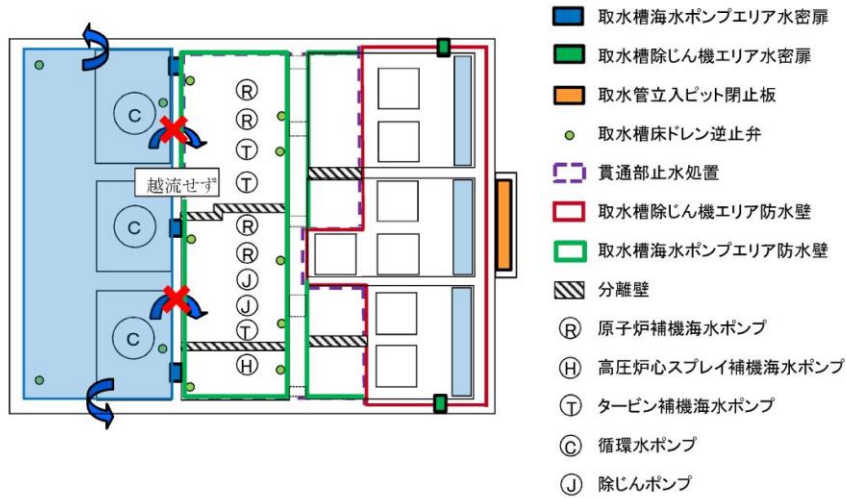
取水槽海水ポンプエリア平面図 (循環水系配管破損時)
